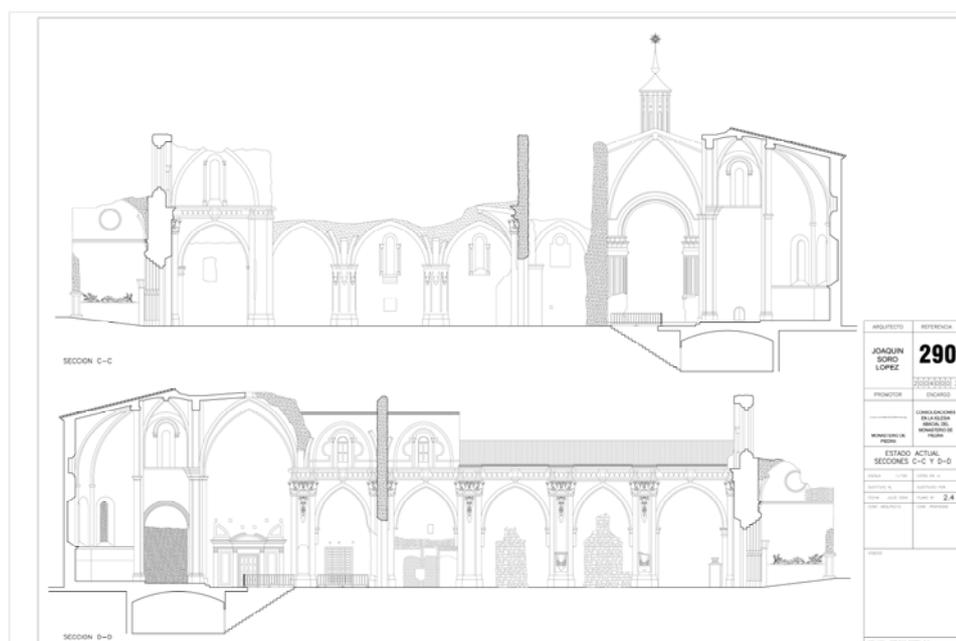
(Proyecto JUL 2004, plano 2.4.) ESTADO ACTUAL. SECCIONES LONGITUDINALES.
